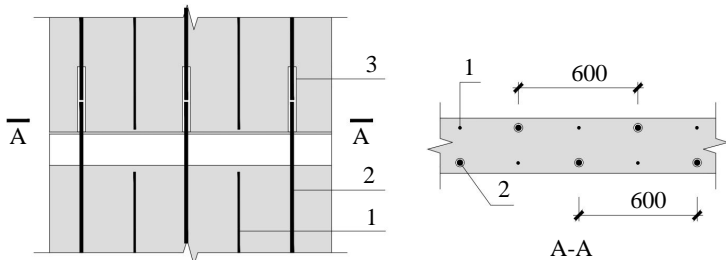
竖向分布钢筋“梅花型”套筒灌浆连接构造示意
